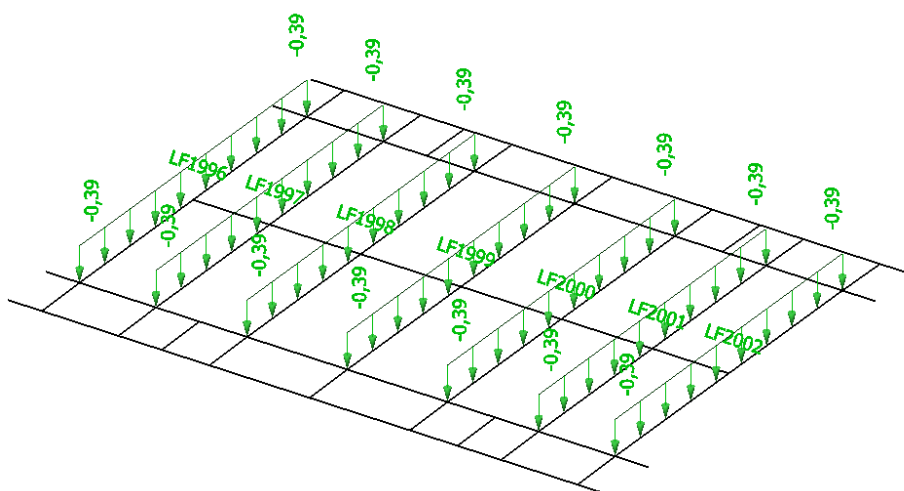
Rošty a zábradlí lávek divadelní techniky detail
